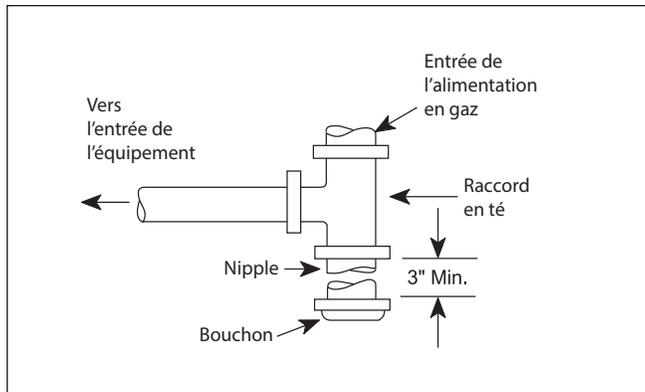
Installation d'un piège à sédiments sur raccord en T.
